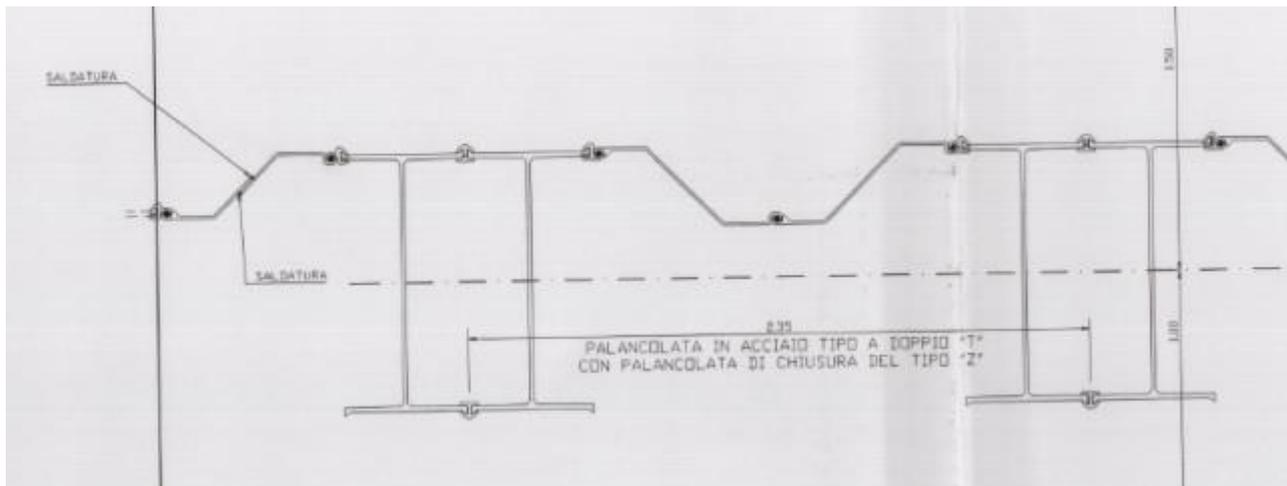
Sezione del palancolato di banchina, HZ975-24/ZH13 (da progetto del 1998)
